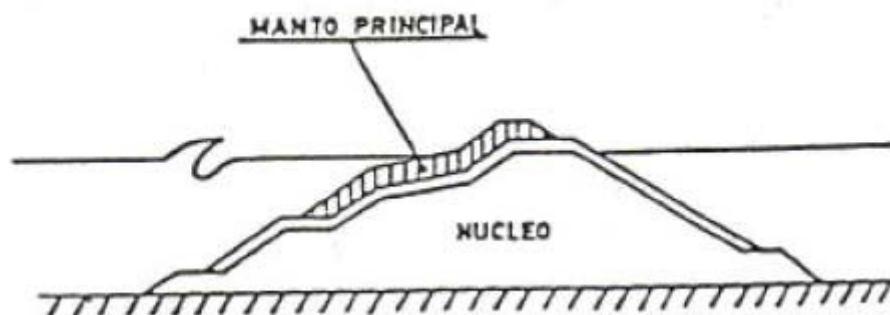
Sección de dique con perfil en S o perfil compuesto
